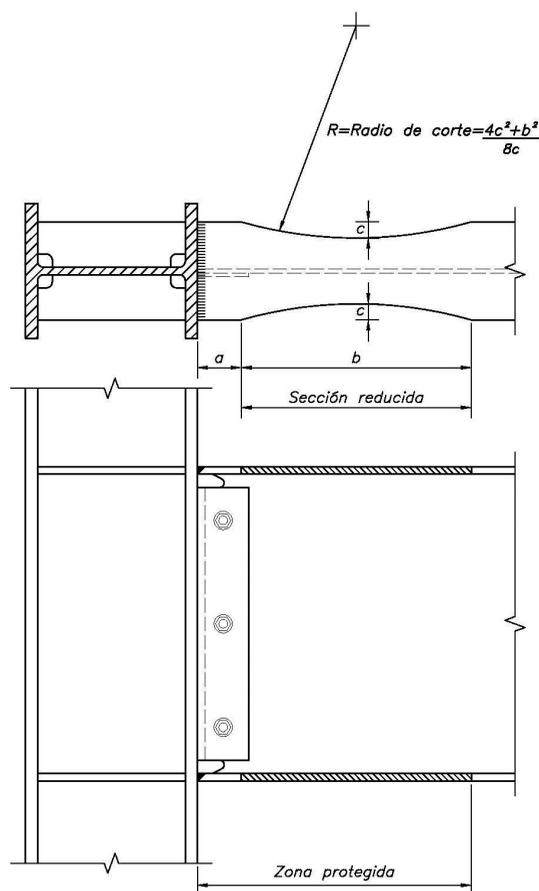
Elementos principales de la conexión de sección de viga reducida (RBS).
